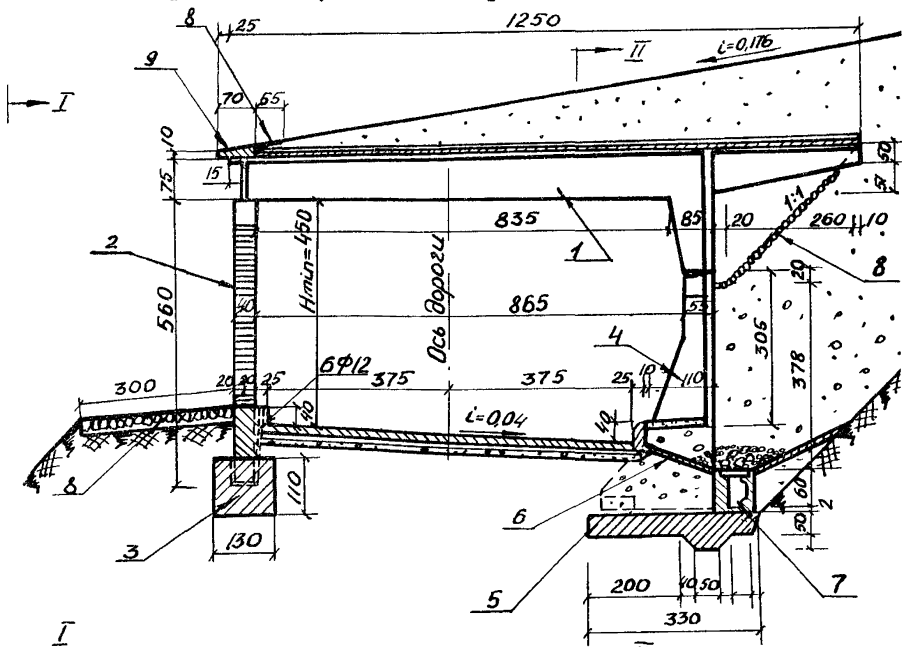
Поперечный разрез сборной балочно-консольной железобетонной галереи: 1—ж.б. одноконсольный Т-образный блок перекрытия; 2—ж.б. сквозные блоки низовой опоры; 3—бетон фундамента низовой опоры; 4—ж.б. контрфорсные блоки верховой опоры; 5—бетон фундамента верховой опоры; 6—водонепроницаемый экран из тощего бетона = 10 см; 7—лоток застенного дренажа; 8—одиничное кошение на цементном растворе; 9—армированный бетон карниза; 10—выравнивающий слой цементного раствора = 2 см, гидроизоляция = 1 см и защитный слой бетона = 5 см; II—распорка между низом блоков верховой опоры; I2—консоль ребра блока перекрытия
